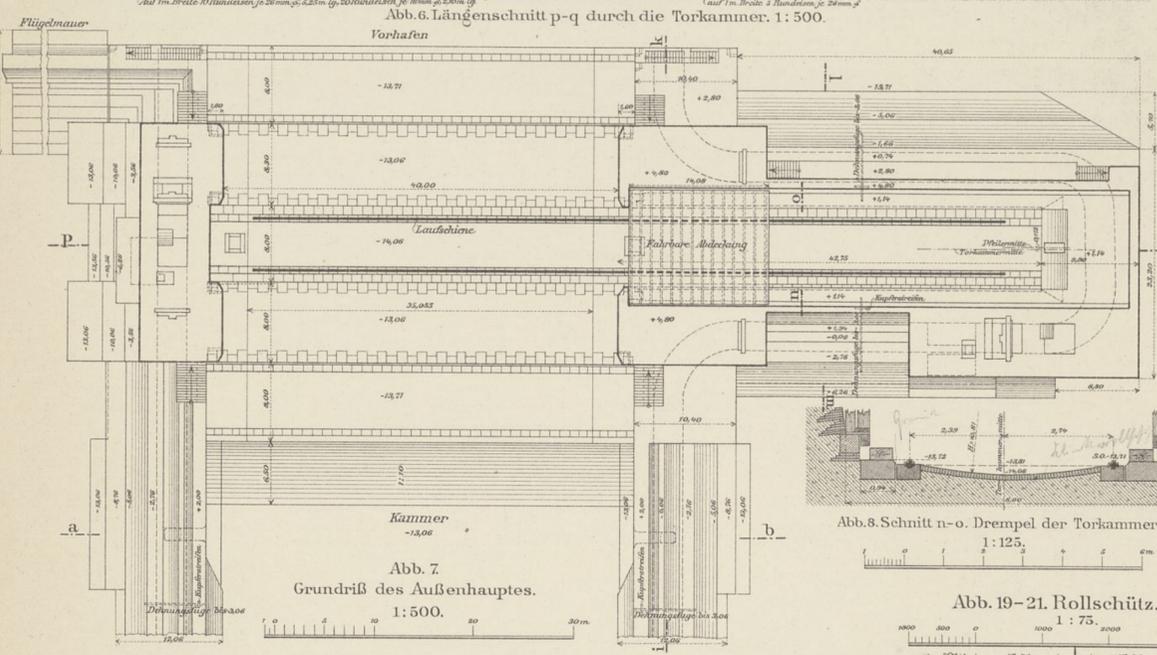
Grundriß des Außenhauptes. 1: 500.
